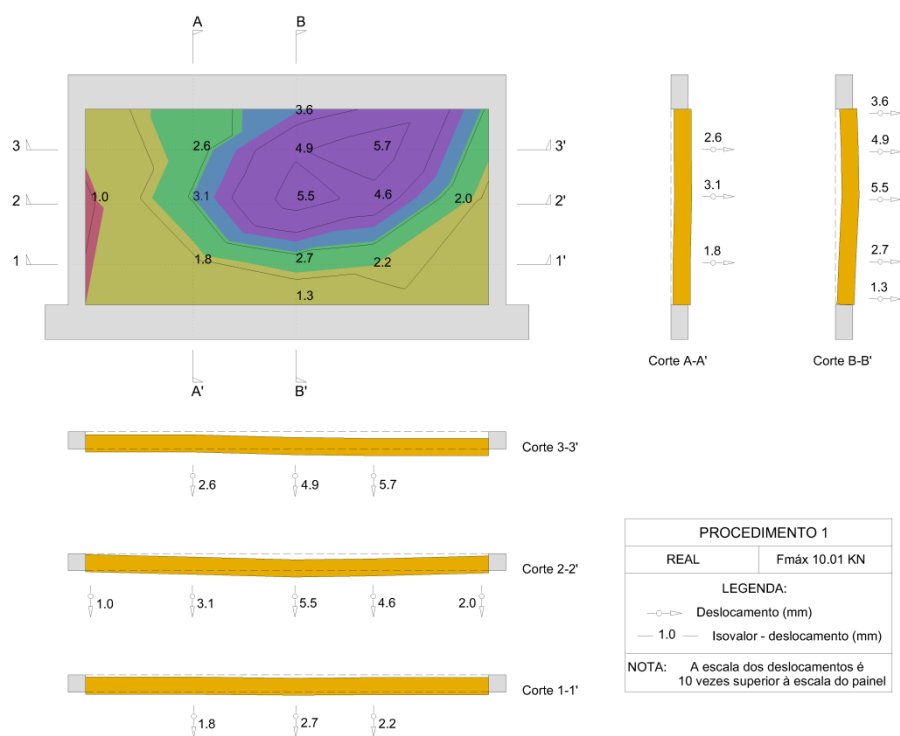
Isovalores da parede ensaiada - Procedimento 1. Ensaio fora do plano, Wall_DPA_01.
